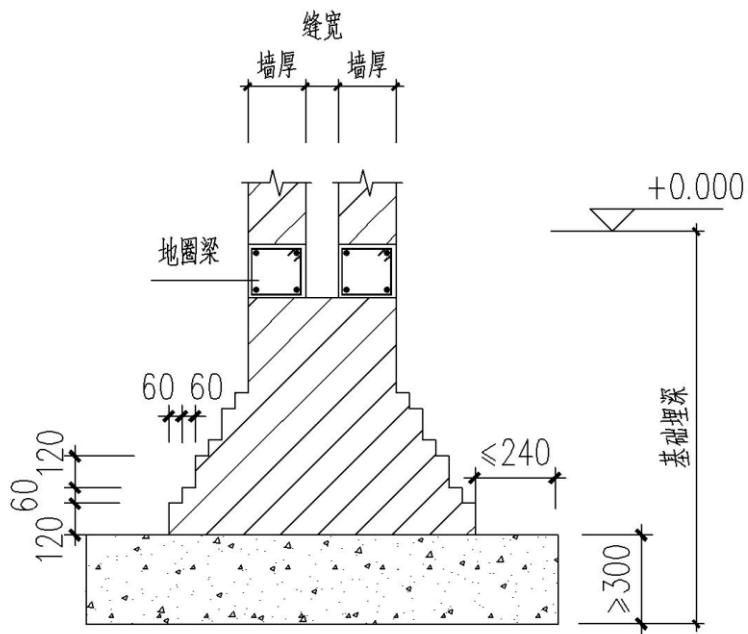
双墙下混凝土、毛石混凝土基础剖面
